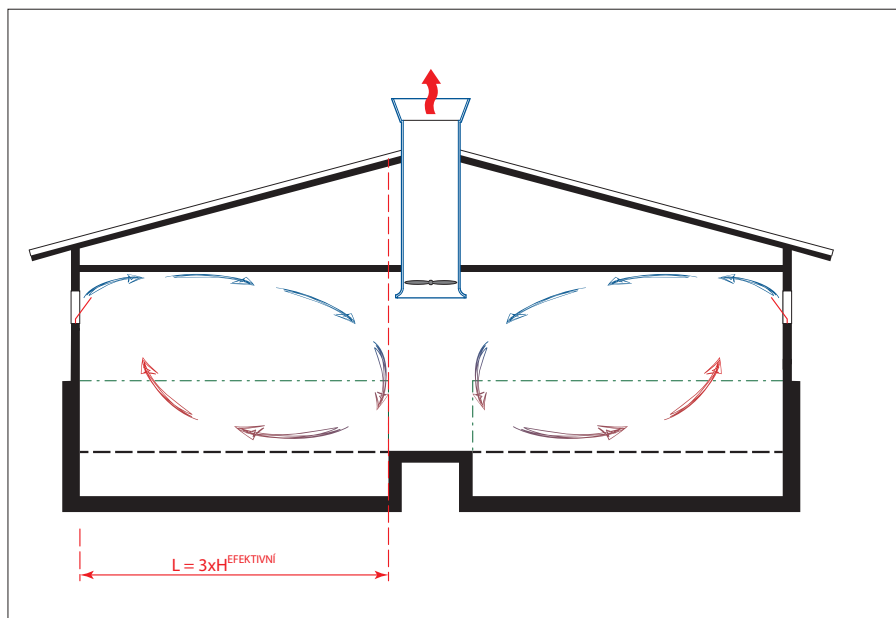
Zobrazení efektivní výšky u různých typů stájí
